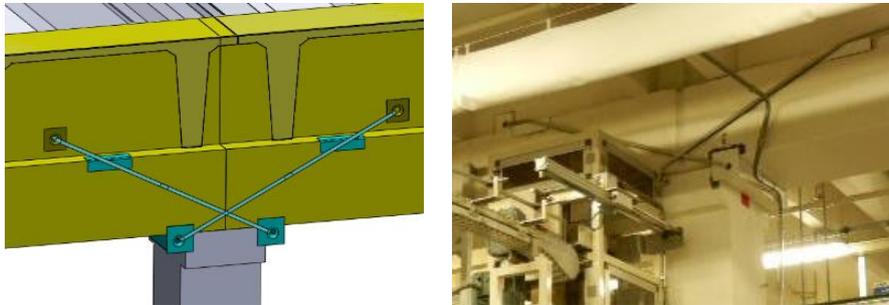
Legatura pilastro-trave: compatibilità con macchinari ed impianti.
